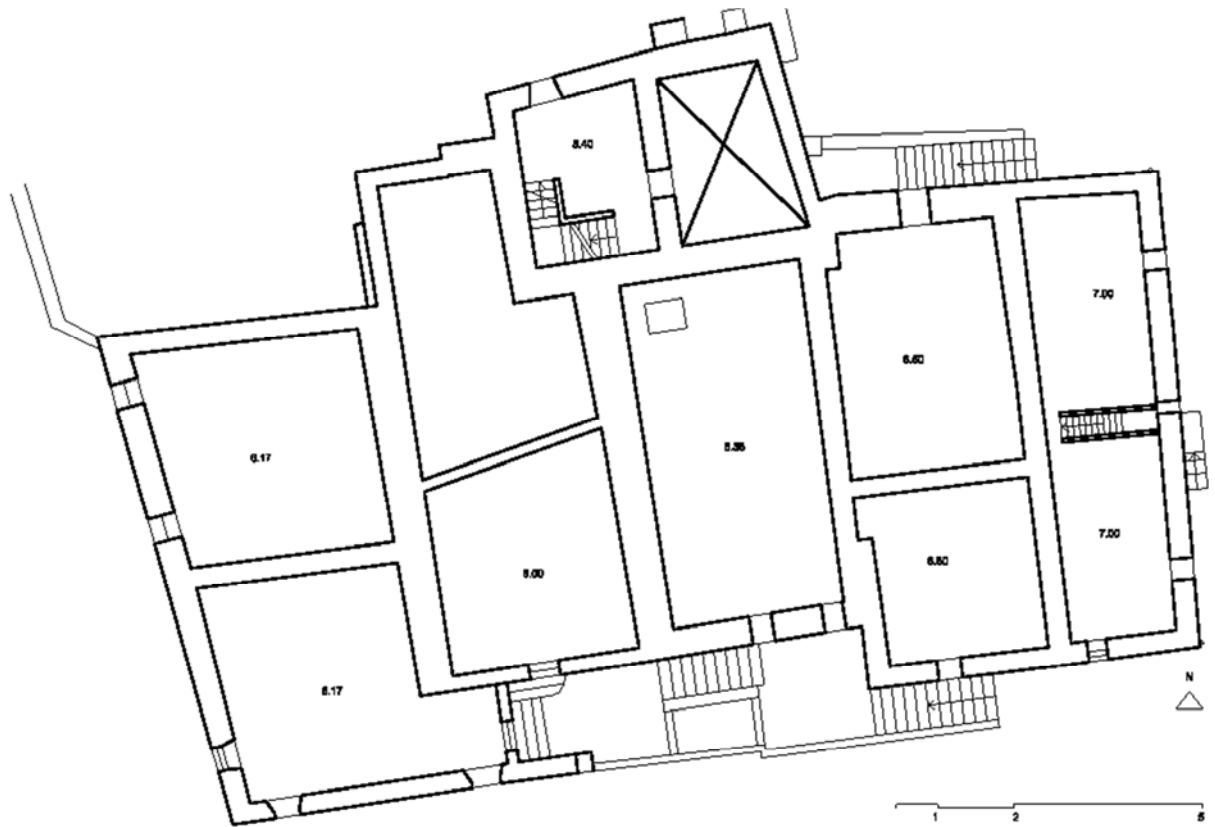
Planimetria del piano secondo. Scala 1:200
